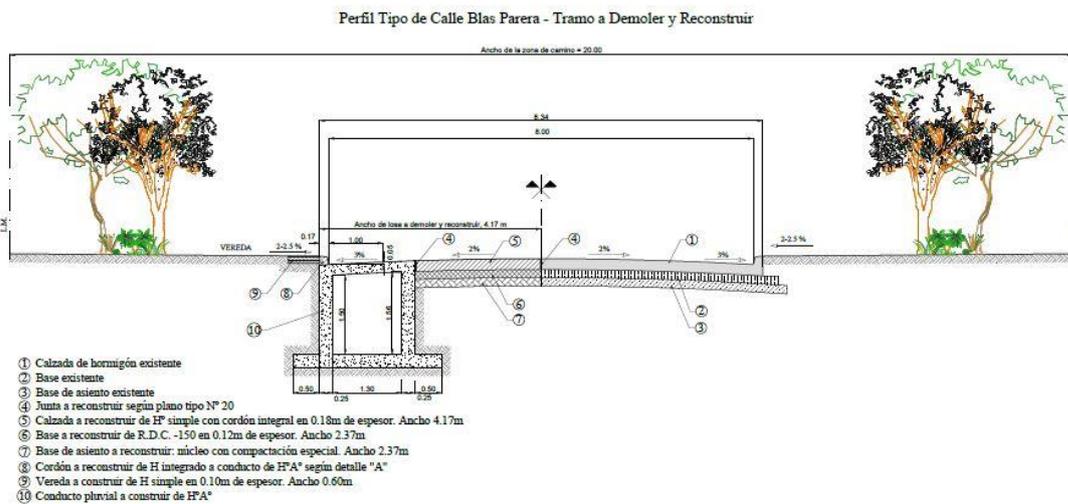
Perfil de Obra tipo Calle Blas Parera -Fuente: Informe de Ingeniería.
